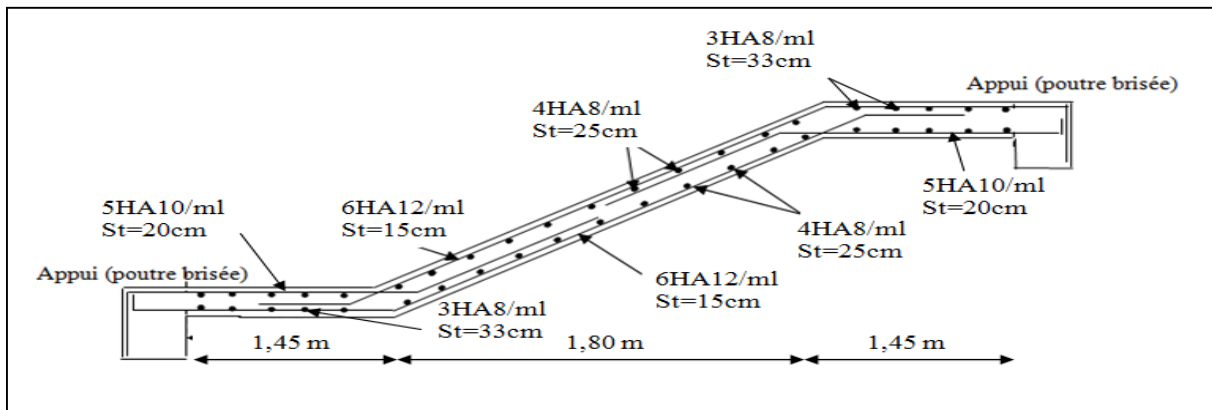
Schéma de ferrailage de l’escalier droit 1 et 3
